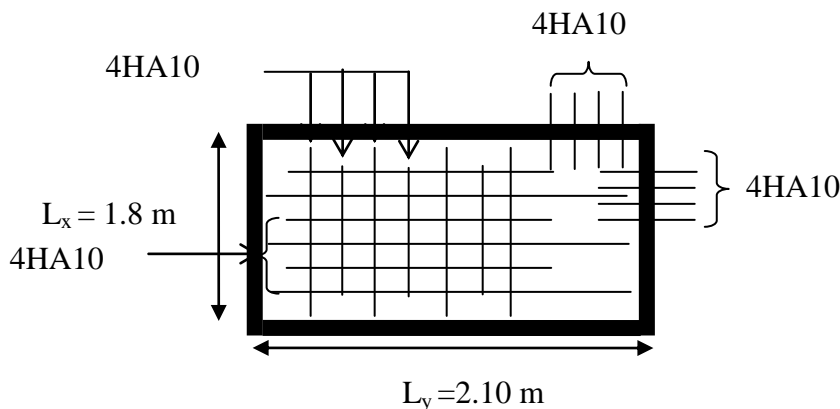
Schéma de ferrailage de la dalle pleine sur 04 appuis
